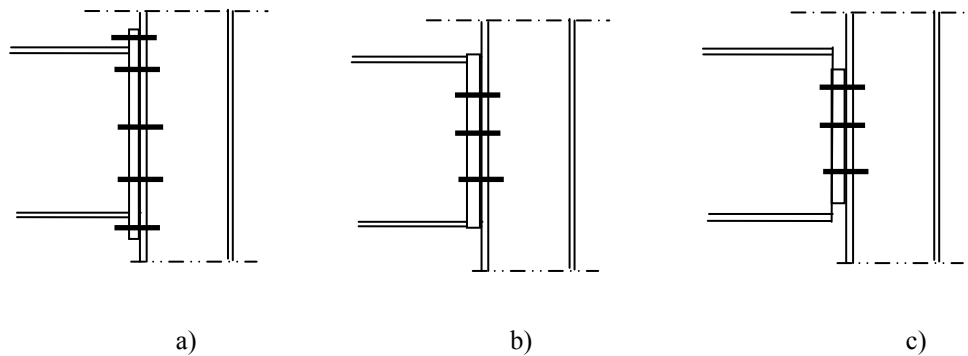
Types d'assemblages par platine d'extrémité : a) Assemblage par platine débordante : (Encastrement parfait), b) Assemblage par platine non débordante (semi-Encastéré), c) Assemblage par platine courte (articulation parfaite).
